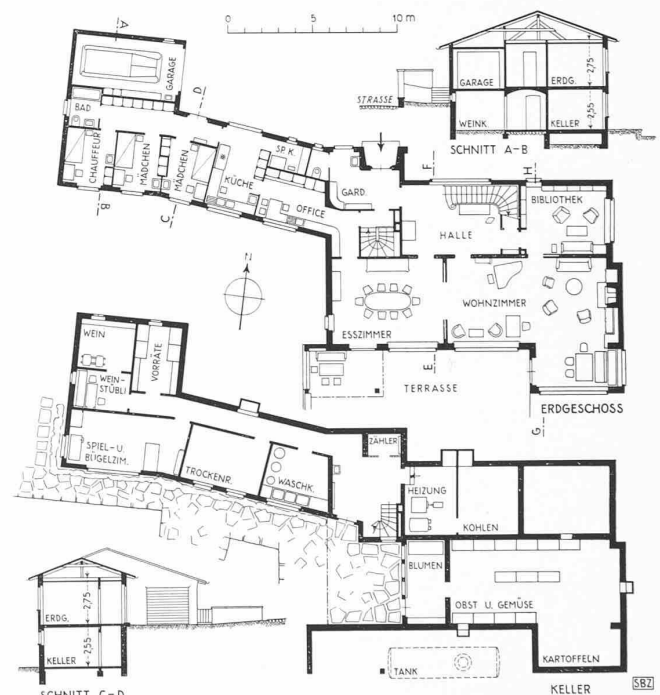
Grundrisse und Schnitte 1:400
